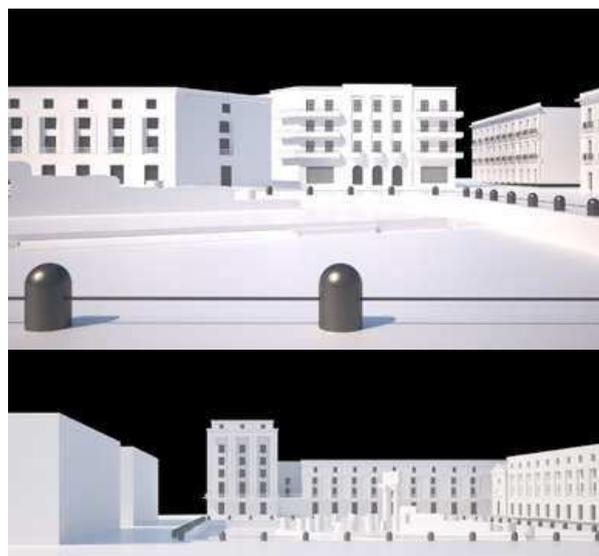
Siracusa, Modello costruito in base alla disposizione in pianta del progetto di Gaetano Rapisardi (elaborazione dell'autrice, 2023).
